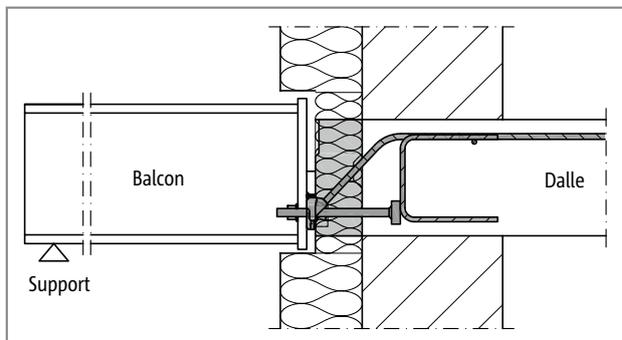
Schöck Isokorb® T type SQ : Raccordement à la dalle en béton ; corps isolant à l'intérieur de l'isolation externe
